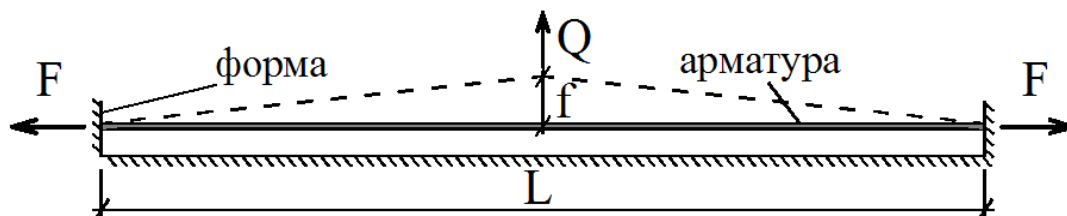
Схема измерения усилий натяжения арматуры методом поперечной оттяжки
